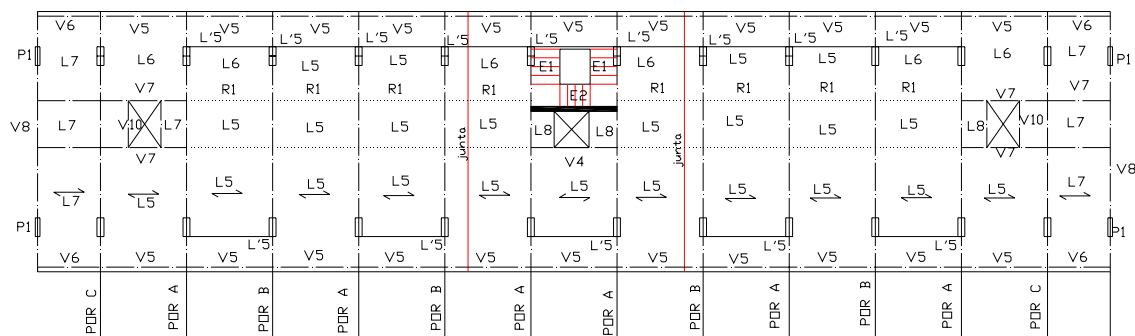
Planta estrutural dos andares inferiores (1º, 3º, 5º, 7º)
